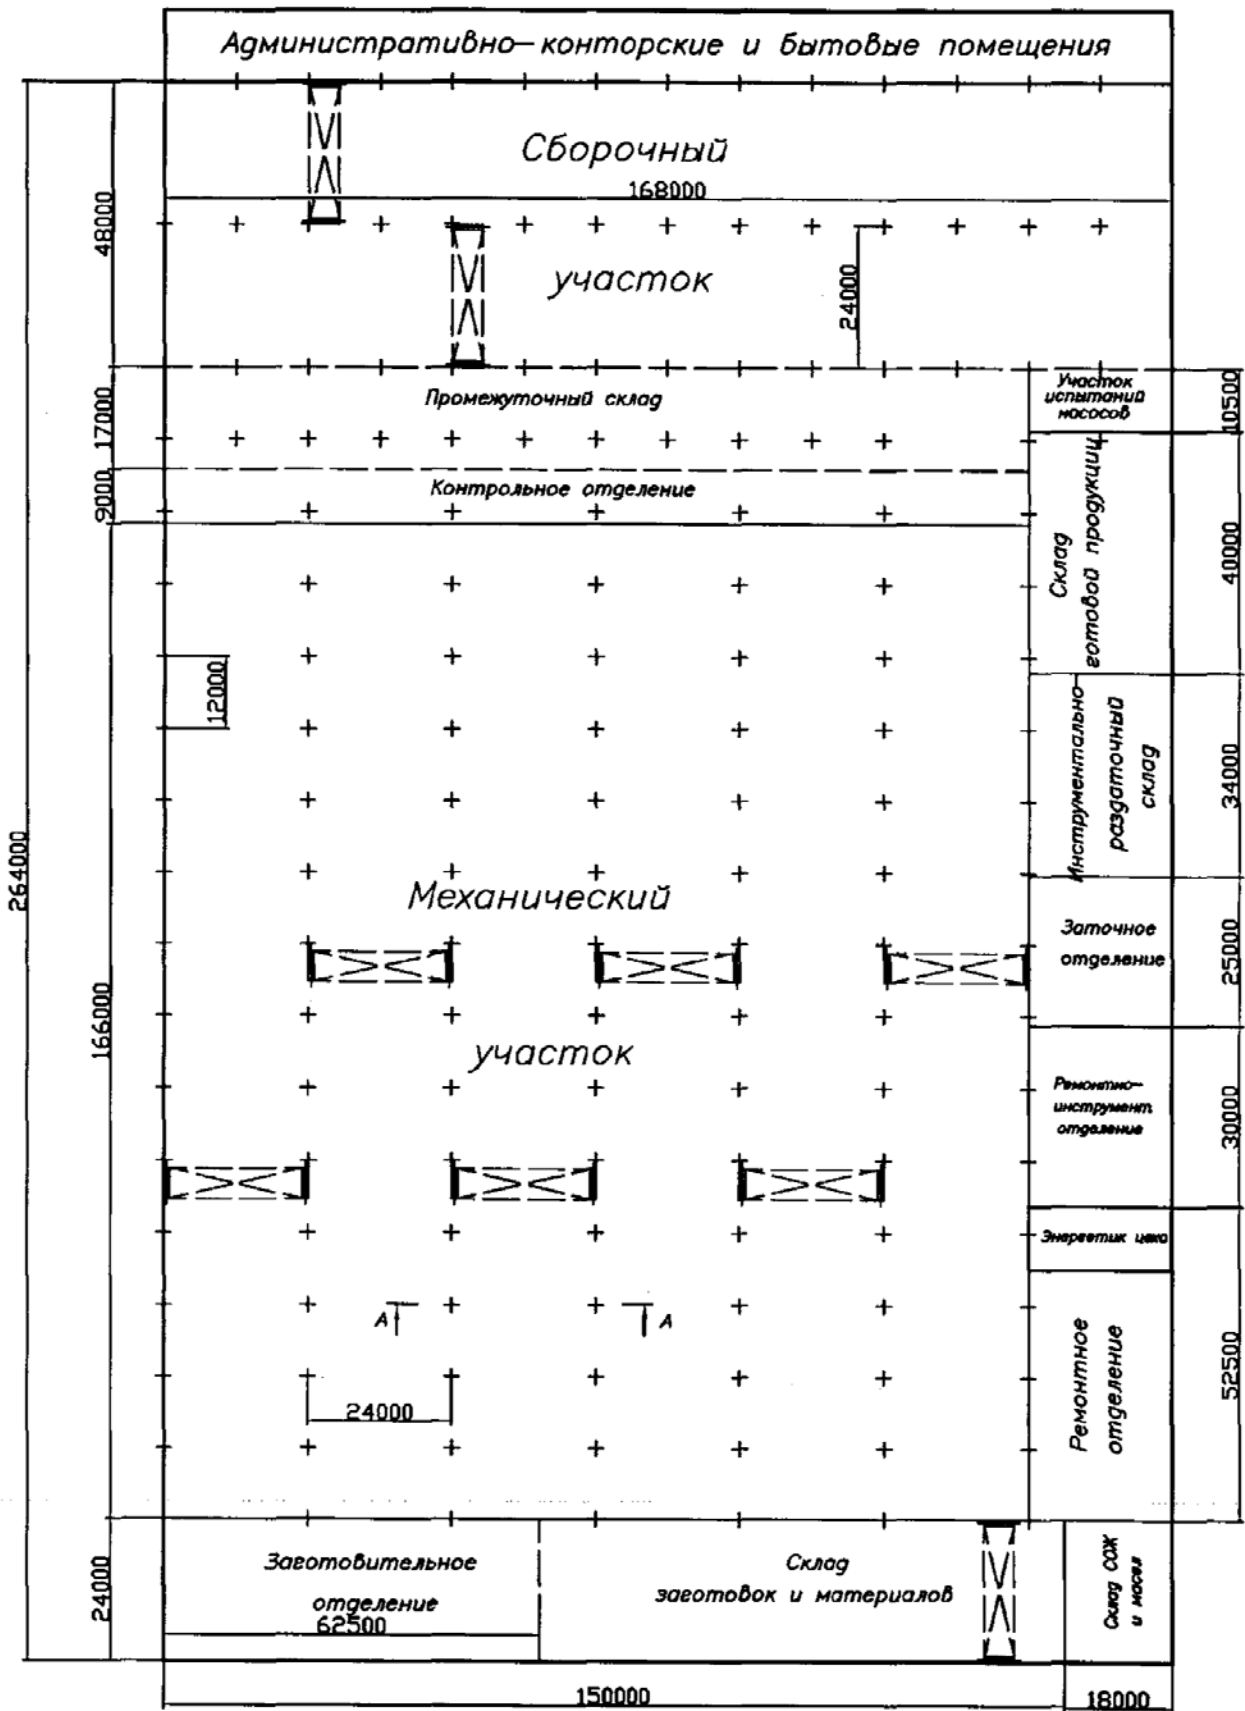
Эскиз компоновки механосборочного цеха
